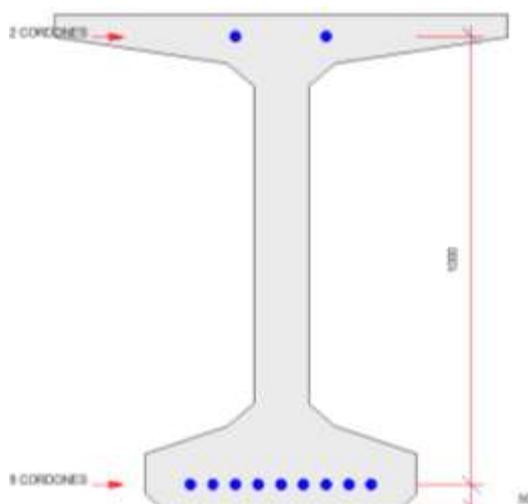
Armadura activa de las vigas de los tableros 1 y 4. Fuente: El. prop.
